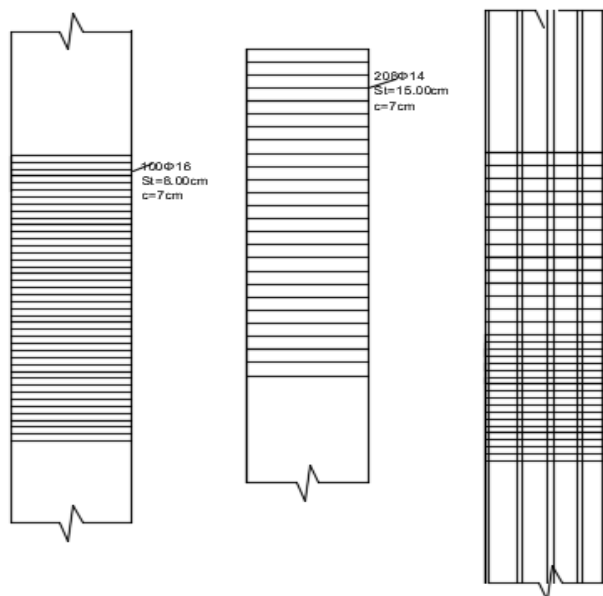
Schéma de ferrailage transversal de deux rangées de pieux
